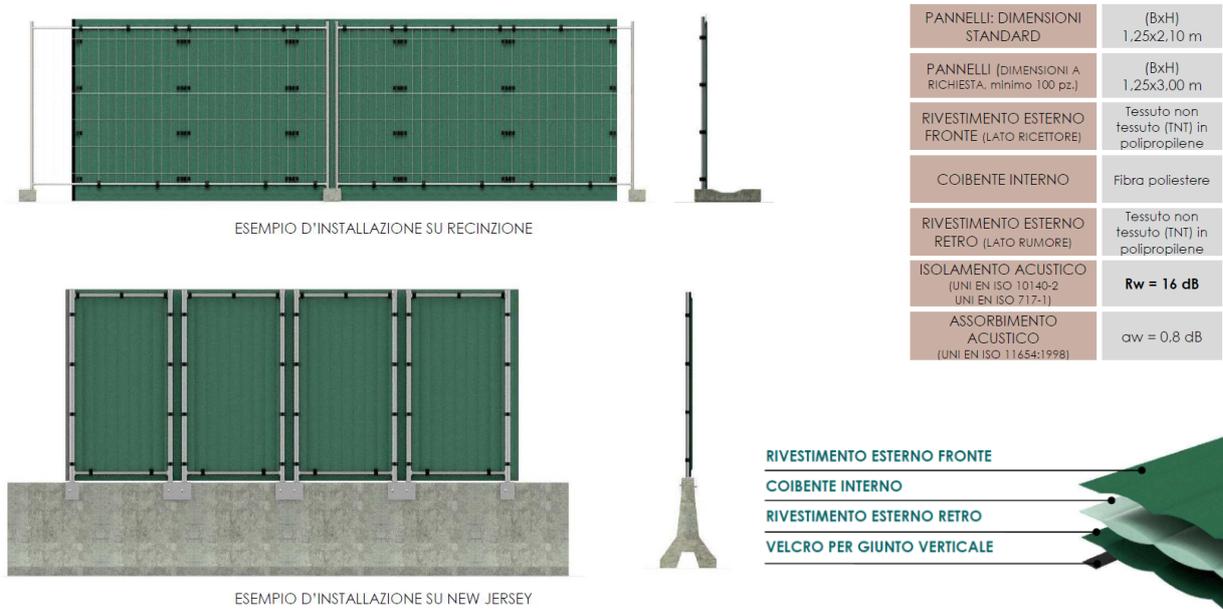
Esempio di pannello fonoassorbente da cantiere
